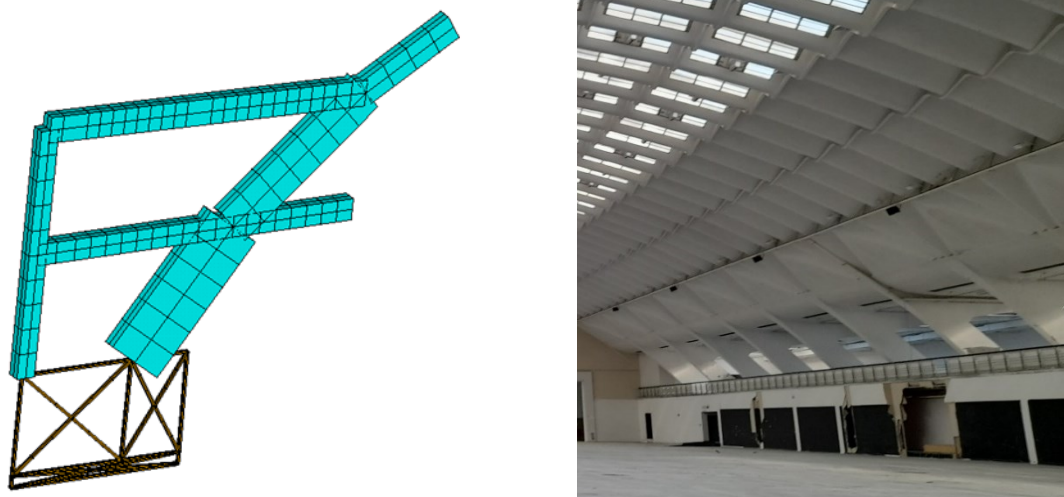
Sinistra, Modello 3D Pilastrone. Destra, fotografia dei pilastroni inclinati lato nord piano terra.
